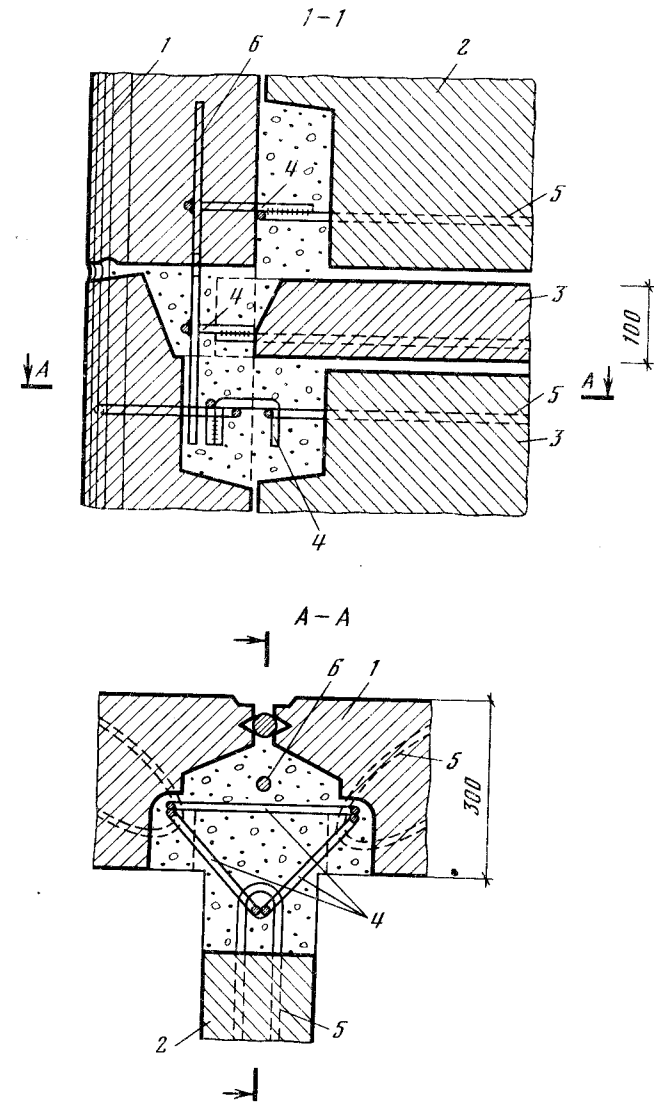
Узел соединения наружных, внутренних стеновых панелей и плит перекрытий
